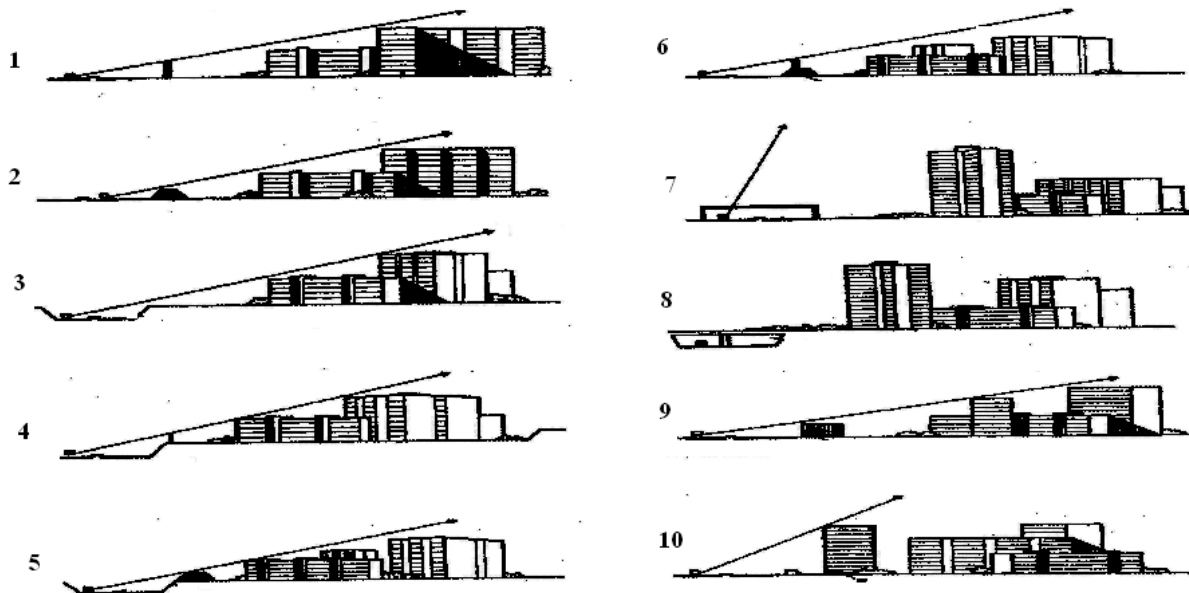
Типи екранів: 1 – стінка; 2 – насип; 3 – виїмка; 4 – тераса; 5, 6 – комбіновані екрани; 5 – виїмка з насипом або стінкою; 6 – насип зі стінкою; 7 – екран-галерея; 8 – екран-тонель; 9 – екран-будинок нежитлого призначення; 10 – екран-шумозахисний житловий будинок.
